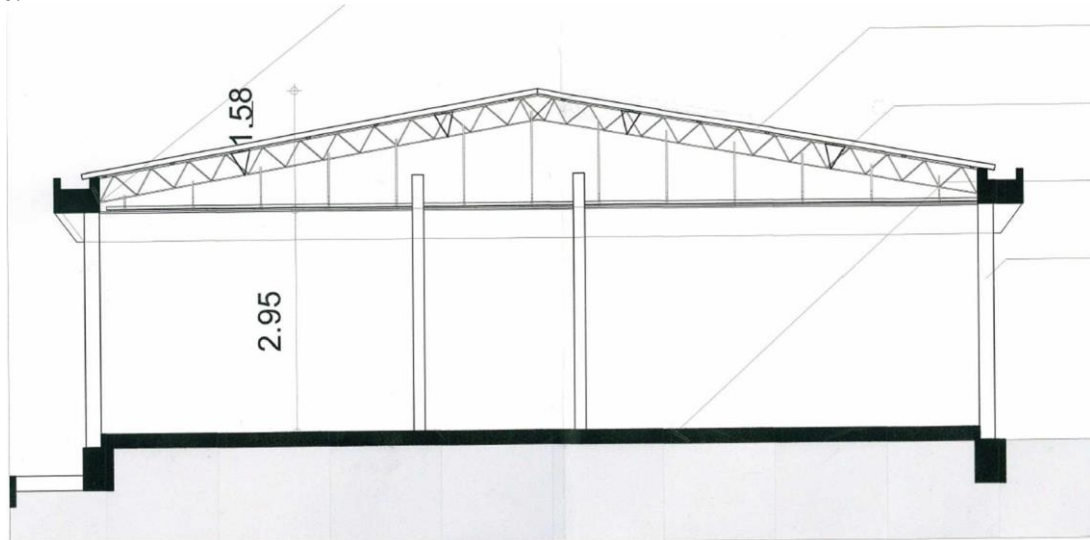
Estructura típica de este conjunto de construcciones que muestra muros débiles, cubierta liviana sin diafragma, cimentación deficiente.
